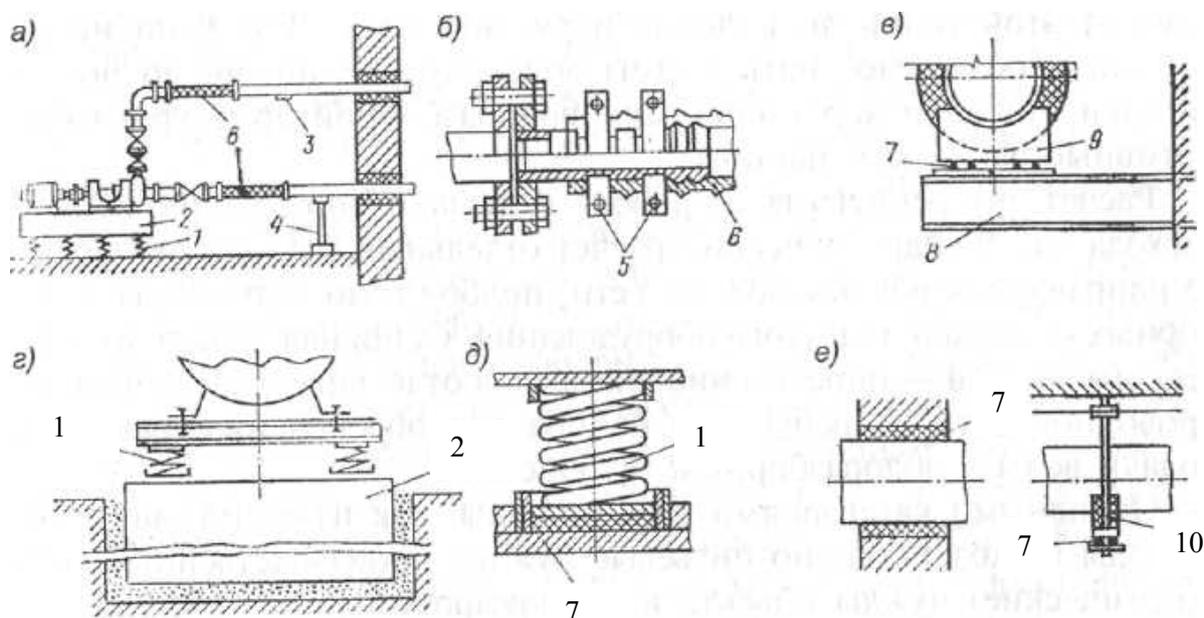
Способы звукоизоляции: *a* – комплексная звукоизоляция насосного агрегата; *б* – крепление гибкой вибровставки; *г*, *в* – насосный агрегат на плавающем фундаменте; *д* – пружинный амортизатор; *е* – заделка трубы в стене и на подвеске; 1 – стальная пружина; 2 – фундамент; 3 – «грузовой» фильтр; 4 – стойка; 5 – хомуты; 6 – вибровставки; 7 – резиновые прокладки; 8 – кронштейн; 9 – деревянная опора; 10 – подвеска
